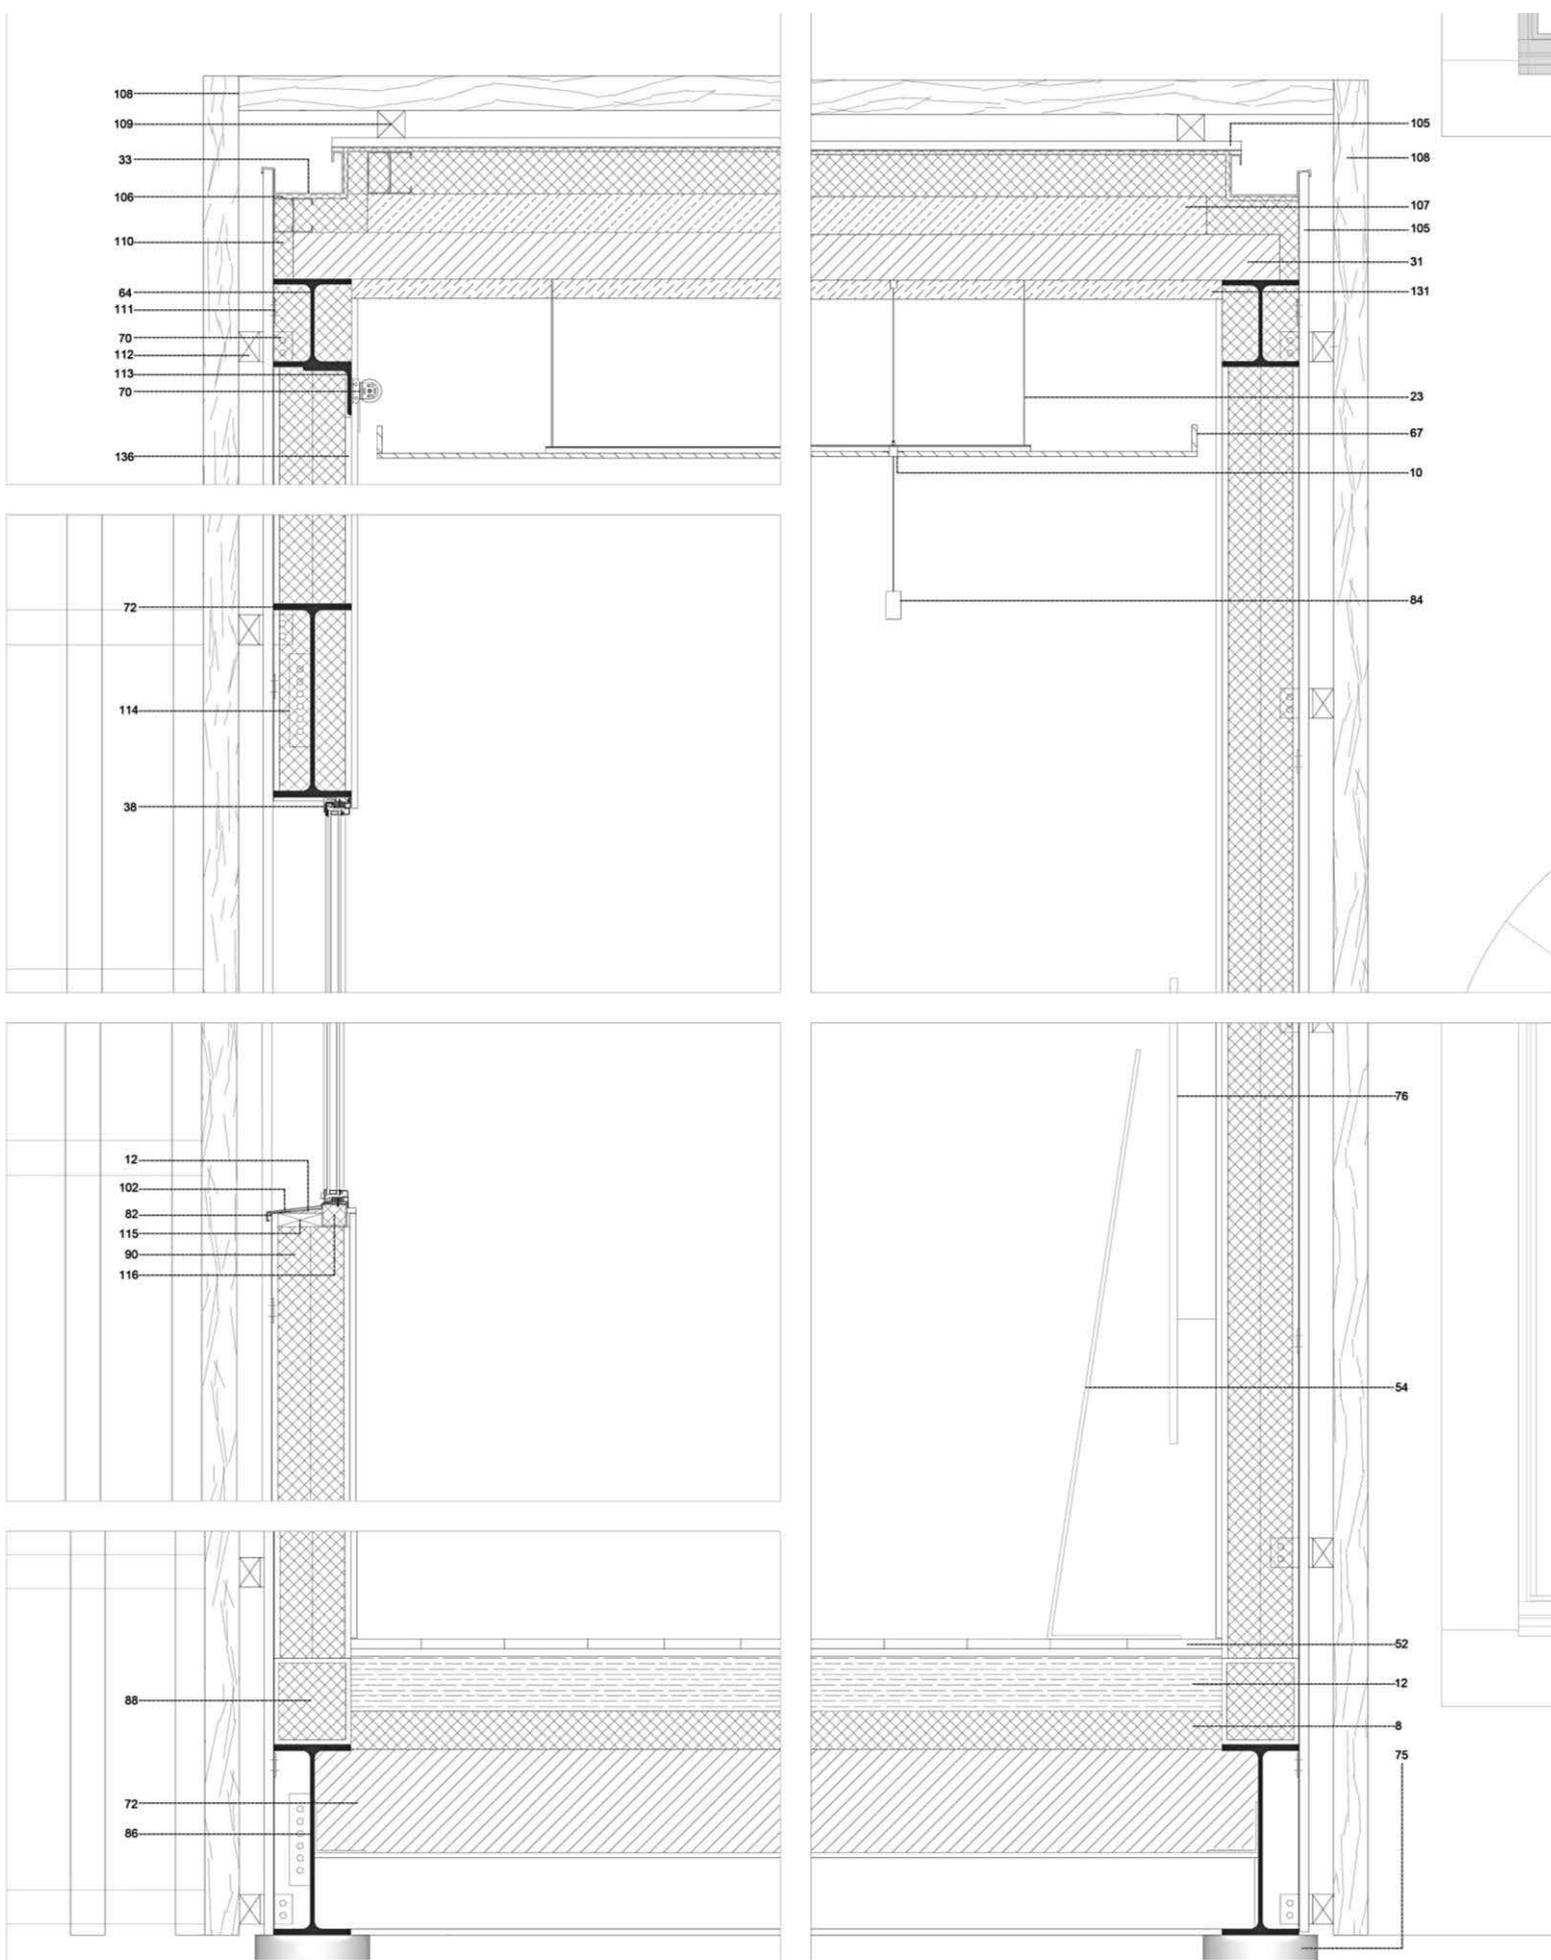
Detalhe construtivo da intervenção, escala 1:10
